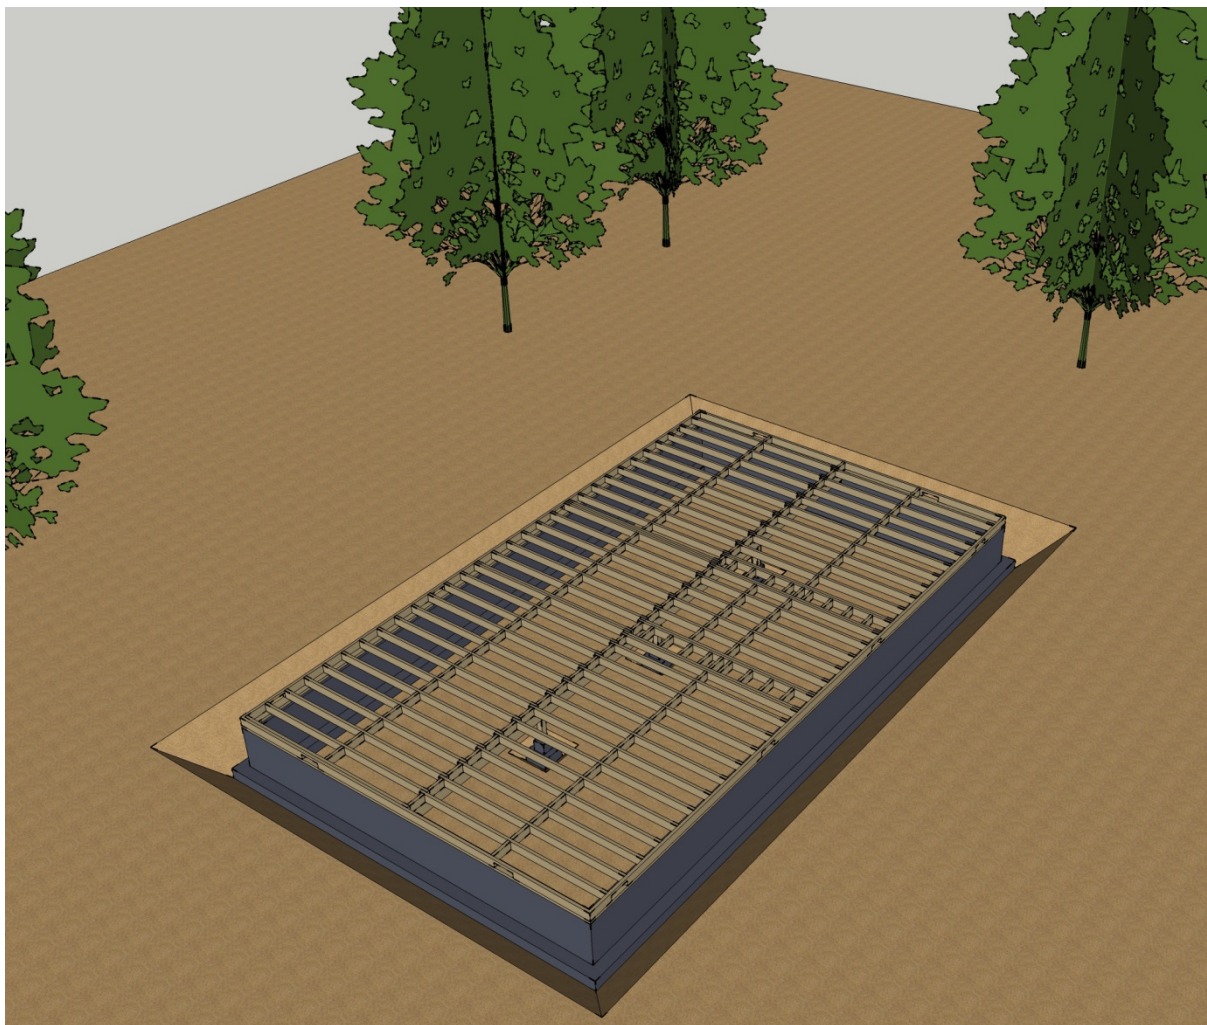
Montagem da viga de bordadura e tarugos.
